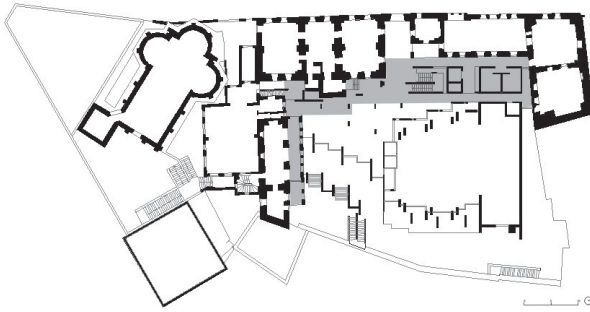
Plano del Centro cultural con la zona de transición, imagen de elaboración propia.
